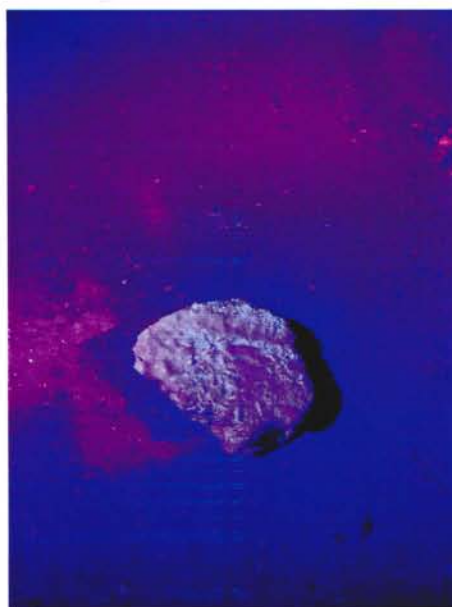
Zdjęcie rdzenia w świetle UV rozpoznające typ warstwy bitumicznej
